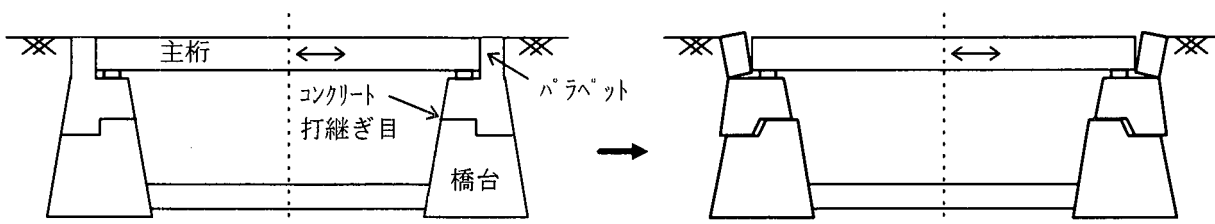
コンクリート打継目がある場合の橋台前面ひび割れ損傷メカニズム
